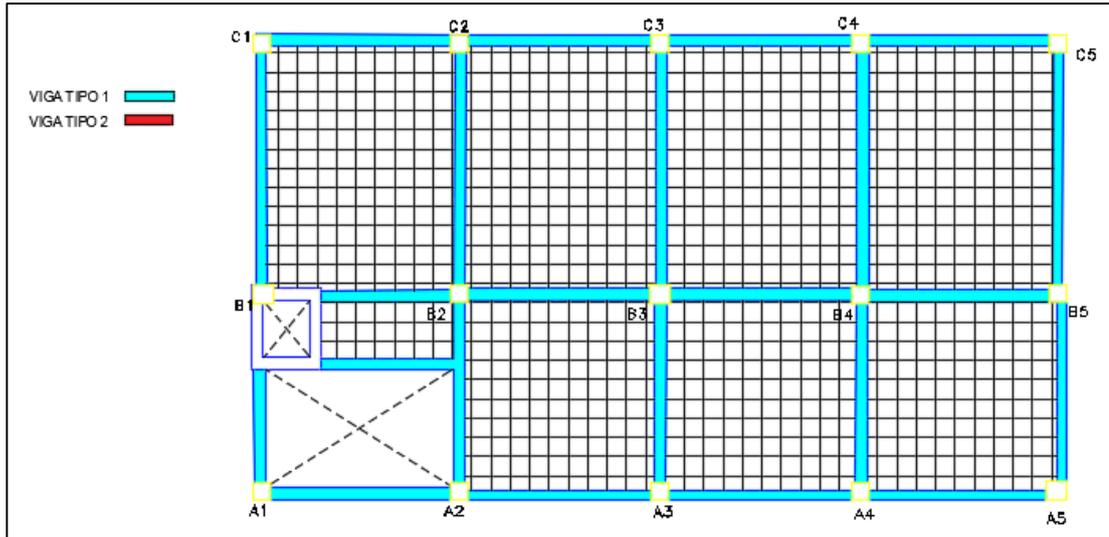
Esquema de distribución de vigas tipo N+4,86 (Hormigón)
